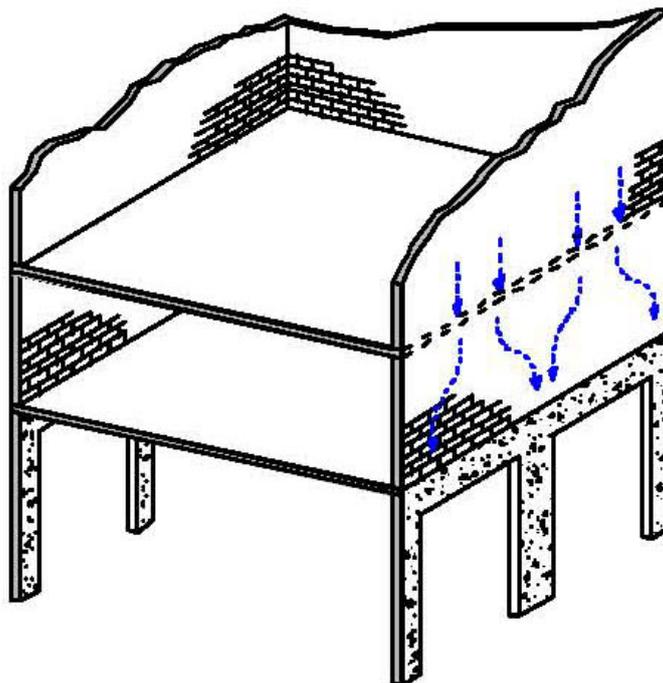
Paredes em Alvenaria Estrutural sobre pilotis em concreto armado (BARBOSA, 2000).
